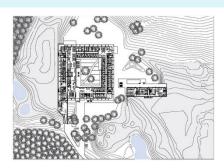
Planta de conjunto Lanserhof Tegernsee. El edificio está emplazado en una superficie plana, sin embargo toda la
